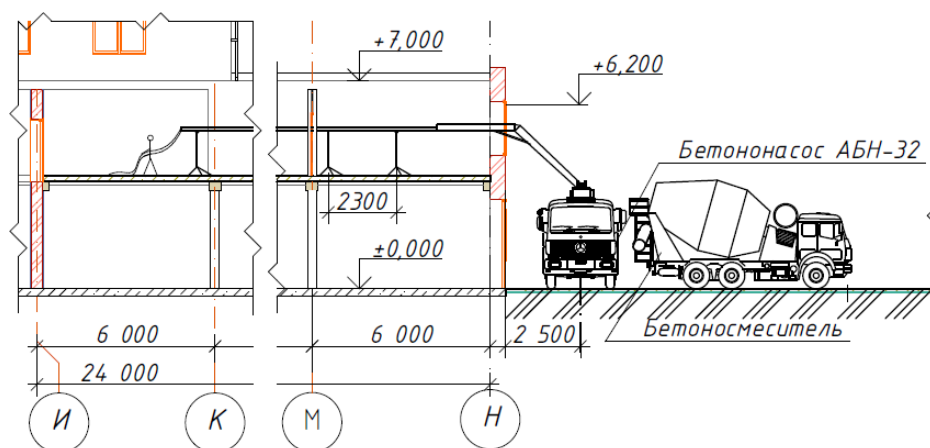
Схема укладки бетонной смеси бетононасосом
